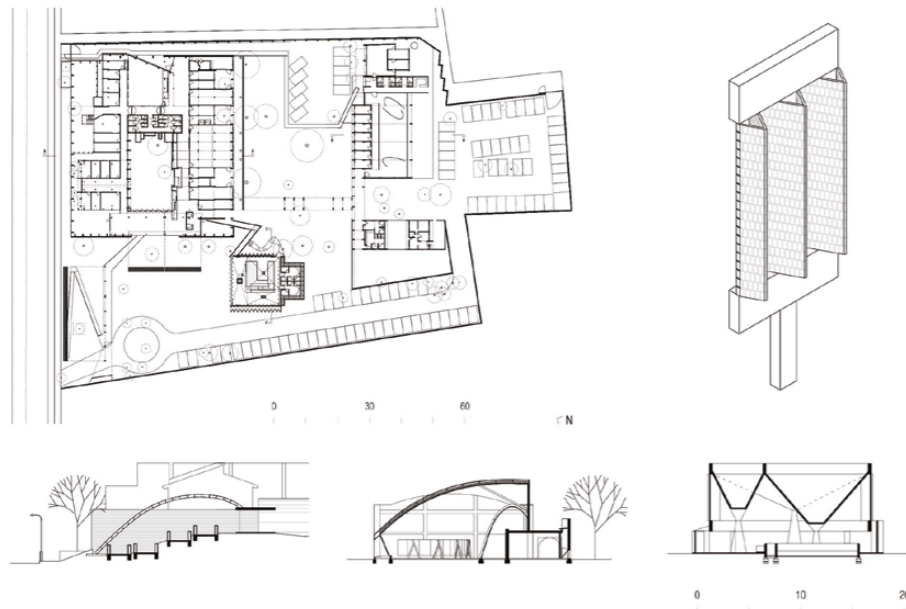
Planta baja, secciones de la cobertura sobre las rampas, del pabellón de fisioterapia y del bloque de hidroterapia, con el detalle de su fachada, en la Fundación Teletón Paraguay (2008-10). Fuente: Dibujos de la autora.
